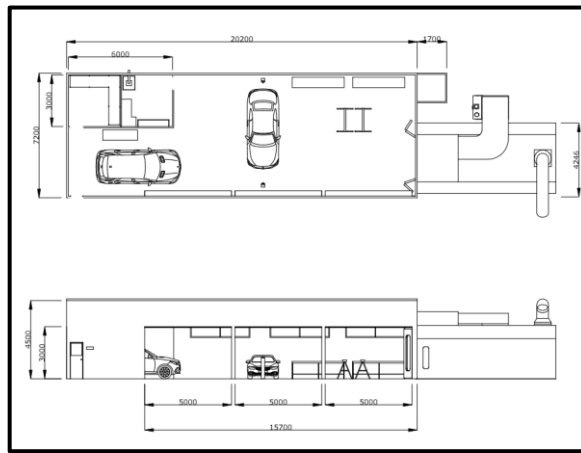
Acercamiento sección de desabolladura y preparación, plano de diseño de "Taller Container".
